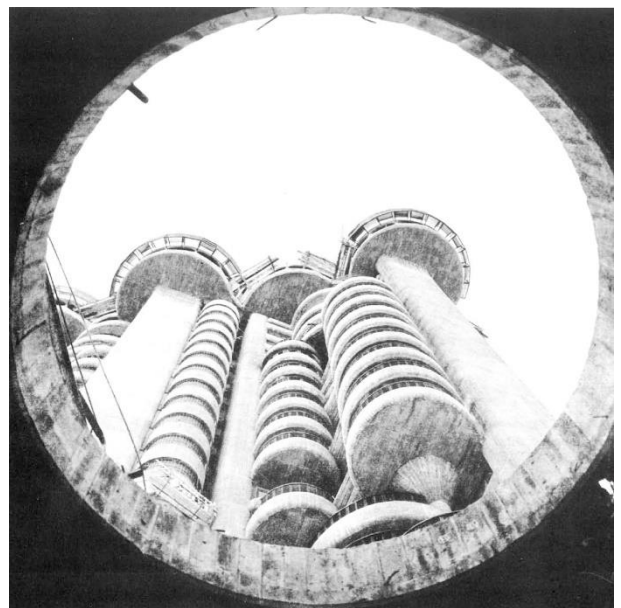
instantánea de arranque de las pantallas estructurales desde la cimentación
